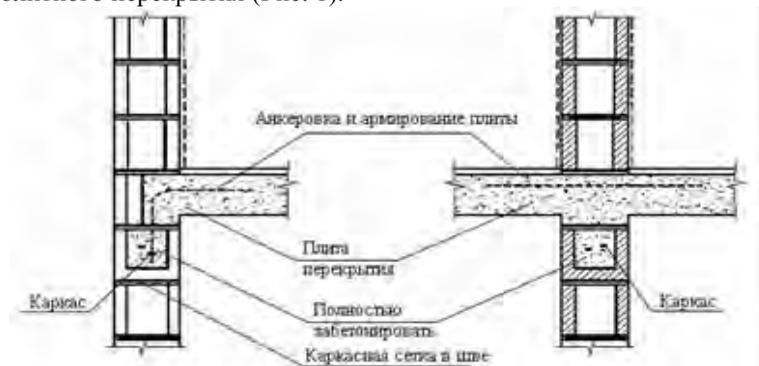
Узлы сопряжения комплексных железобетонных колонн и монолитного перекрытия
